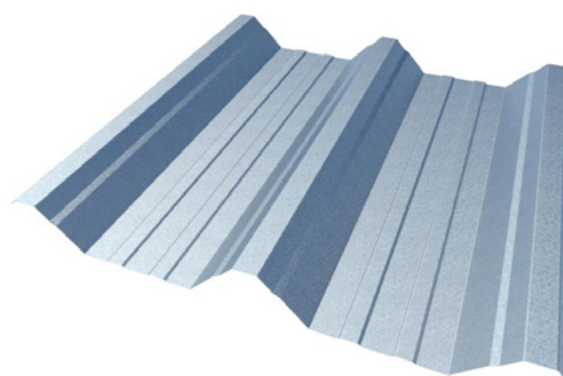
Tipologia de objeto disponível para telha trapezoidal LR100.
